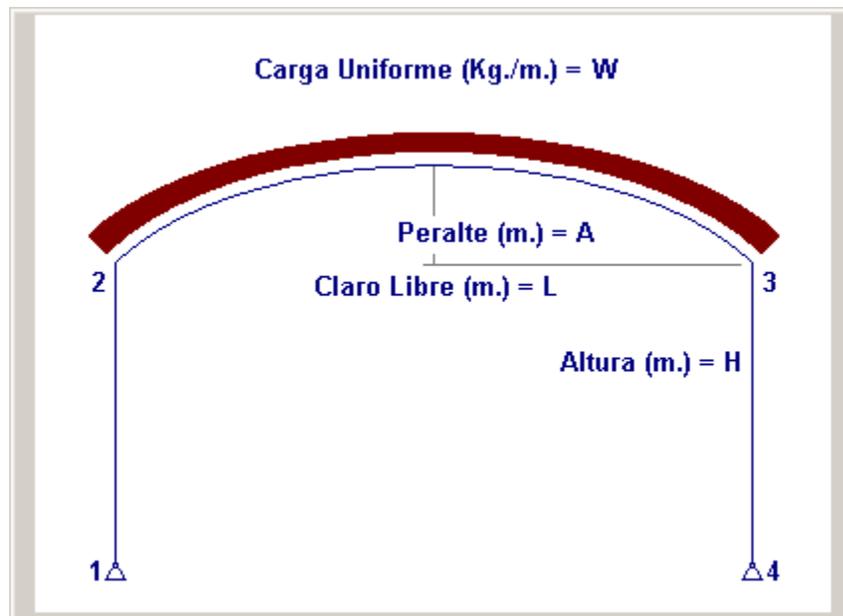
Vista de Marco de Viga Parabólica, Carga Uniforme
